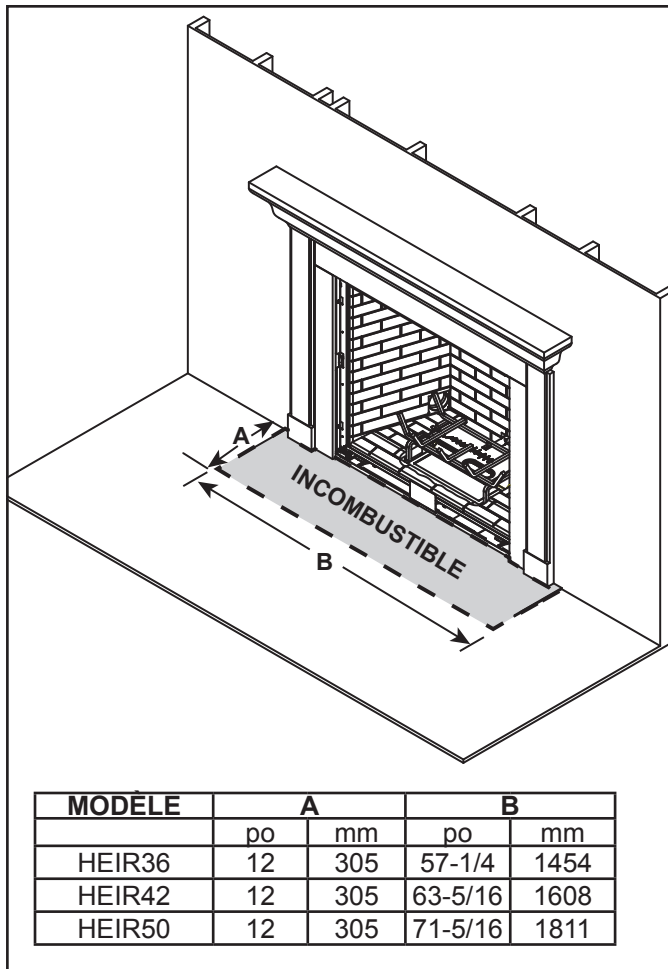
Dimensions du prolongement de l'âtre incombustible
